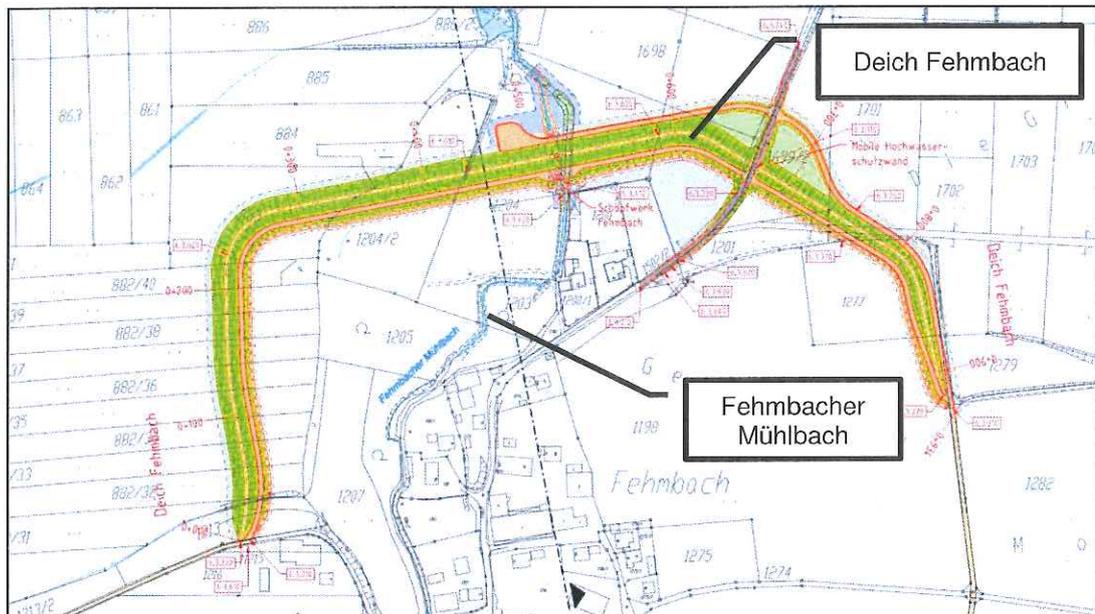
Lageplan Deich Fehmbach (Ausschnitt aus Beilage 27 der PV-Unterlagen)
